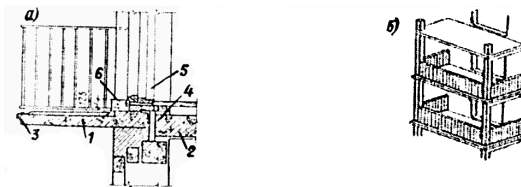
Балконы: а – консольно выступающая плита балкона; б – плита балкона опирается на стену и стойки; 1 – плита; 2 – панель перекрытия; 3 – отлив из уголка; 4 – анкер в железобетонной перемычке; 5 – коробки балконных дверей; 6 – бетонный порог
